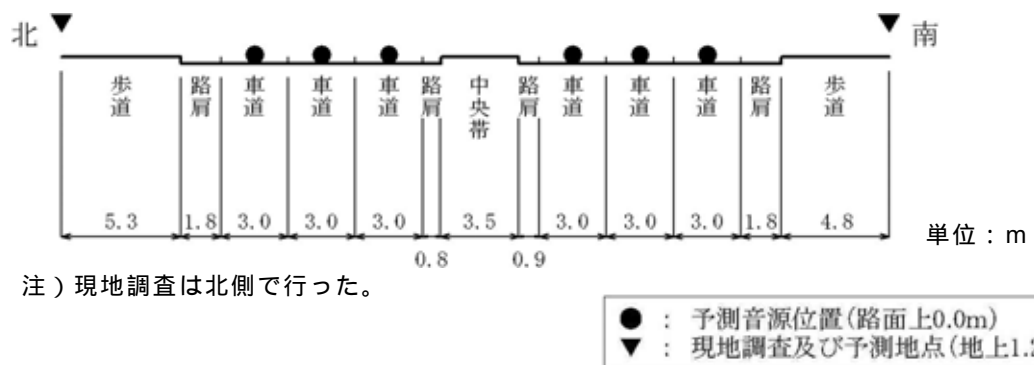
(2) 音源配置図（道路断面方向の配置イメージ：No.3の例）
